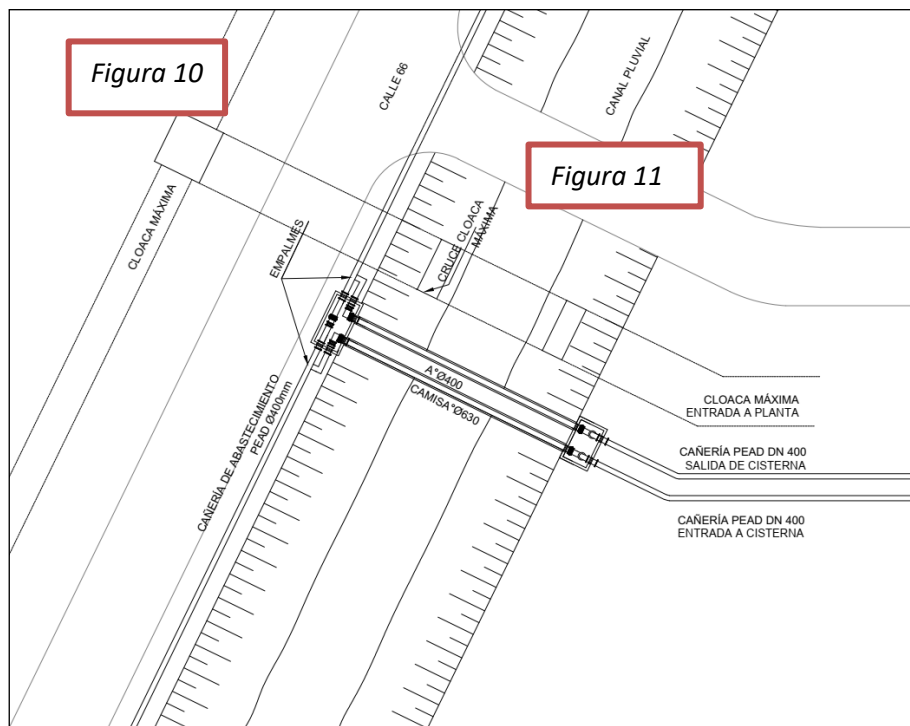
Empalme a cañería existente y cruce de canal pluvial
